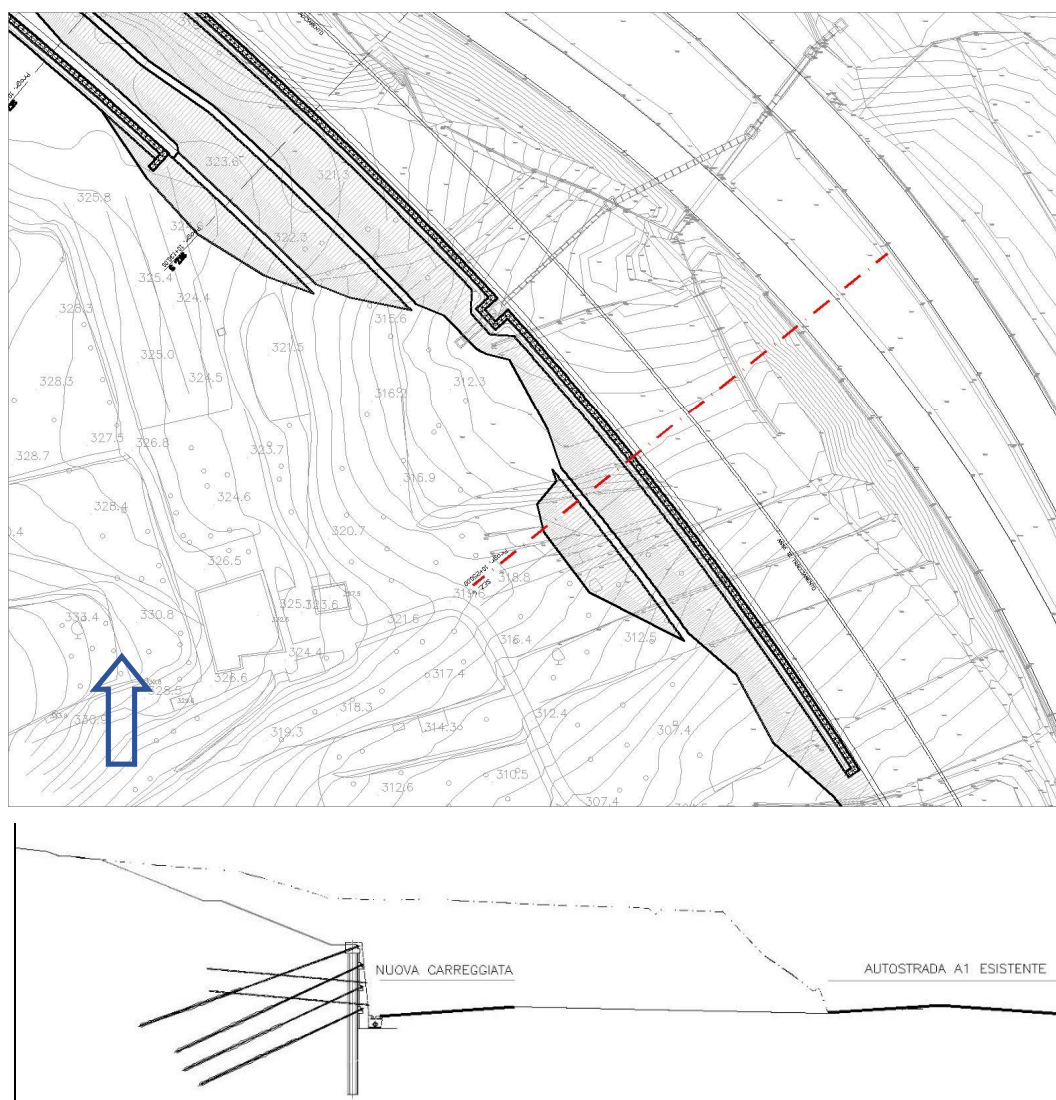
Stralcio della planimetria di progetto contenente le originarie opere geotecniche di difesa del versante (paratia di valle e, in alto a sinistra, la paratia di monte), nonché sezione schematica rappresentativa, con indicazione del profilo di terreno originario (tratteggiato) e nella configurazione finale, da progetto consegnato e mandato in appalto.
